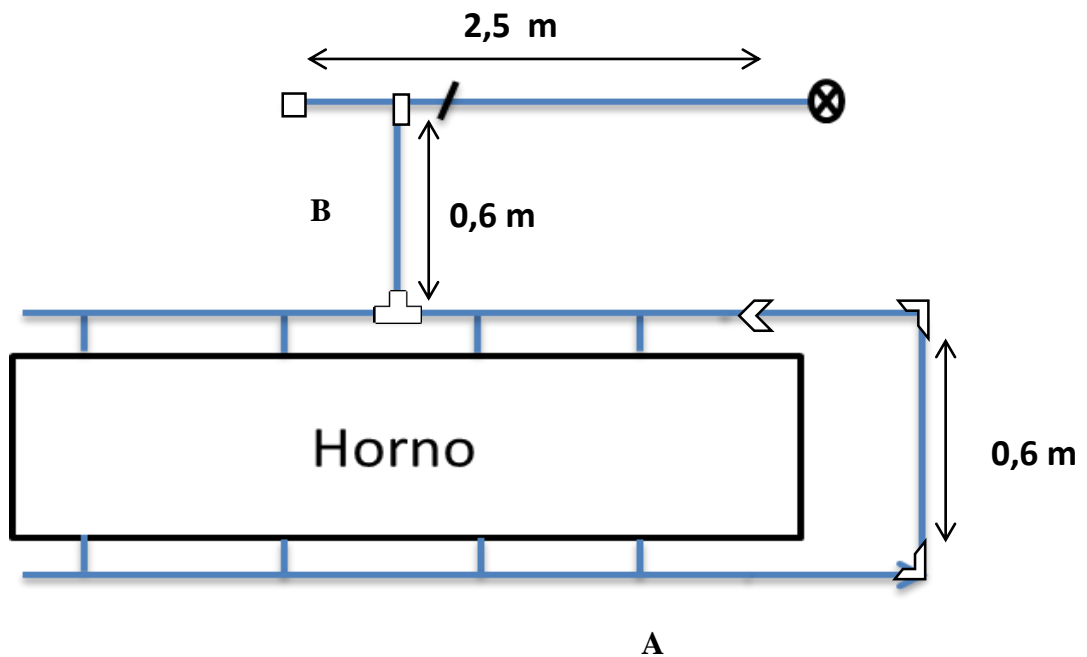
Esquema del tramo 1 (vista horizontal).
